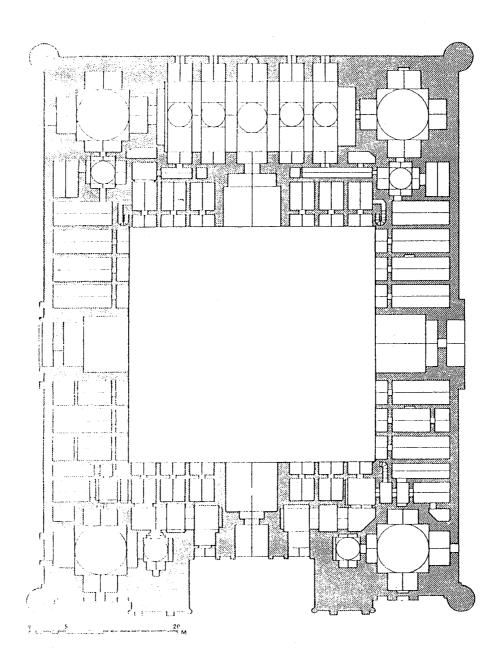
مسقط أفقي لمدرسة اسحاق باشا في اينه كول (عن Goodwin).
